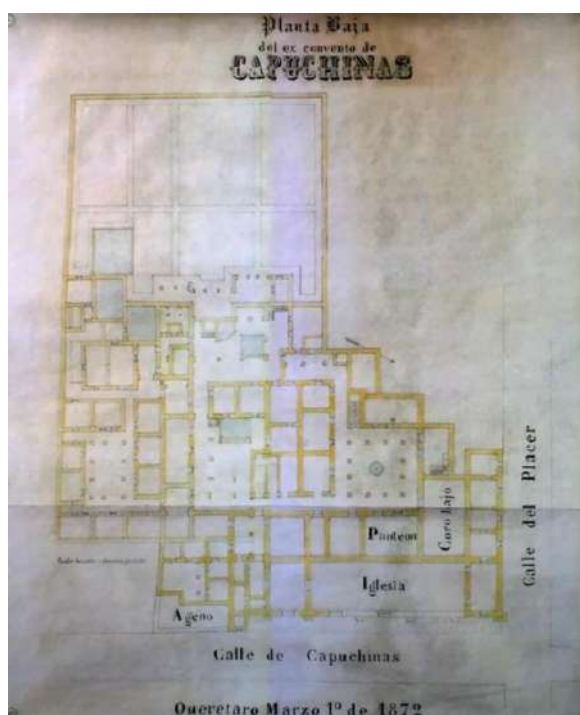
Plano de la Planta Baja del ex convento de Capuchinas.³⁴⁰
